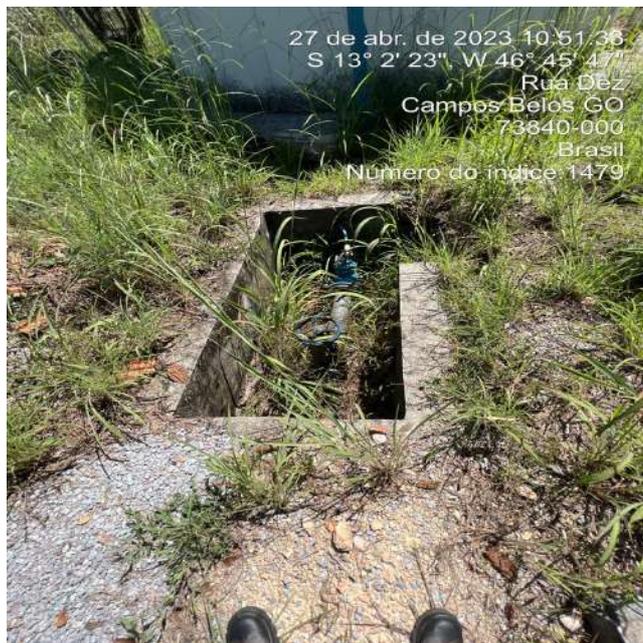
Caixas de passagem sem tampa ou grade de proteção.
